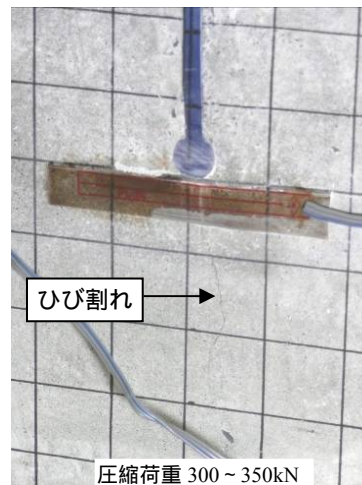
供試体 3 の載荷途中のひび割れ発生状況
